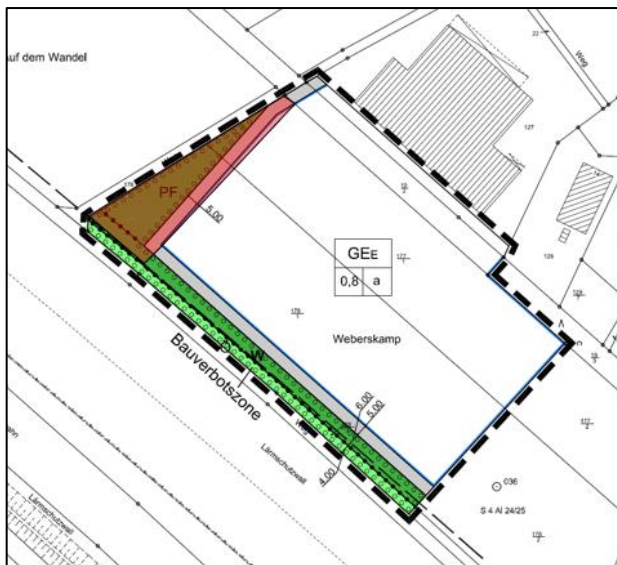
Ausschnitt vorhabenbezogener Bebauungsplan Nr. 47; Quelle: Flecken Bardowick
